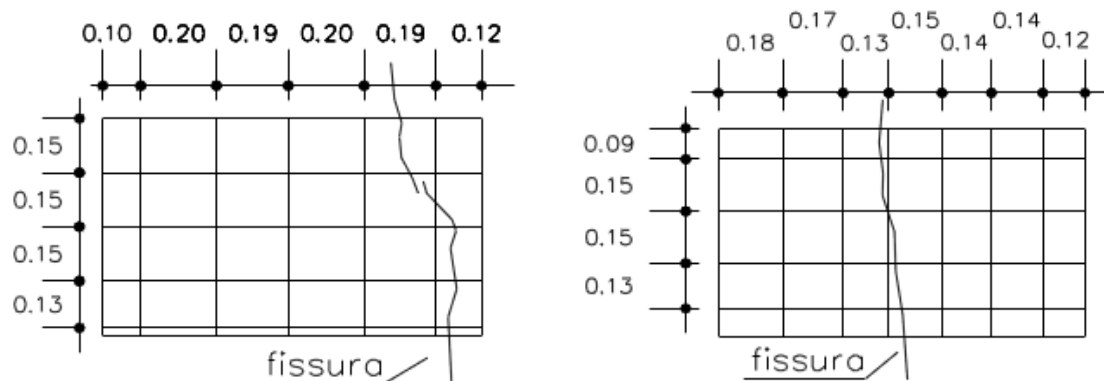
Esquema com a localização das armaduras no ensaio do pacómetro (adaptado de [76]).
